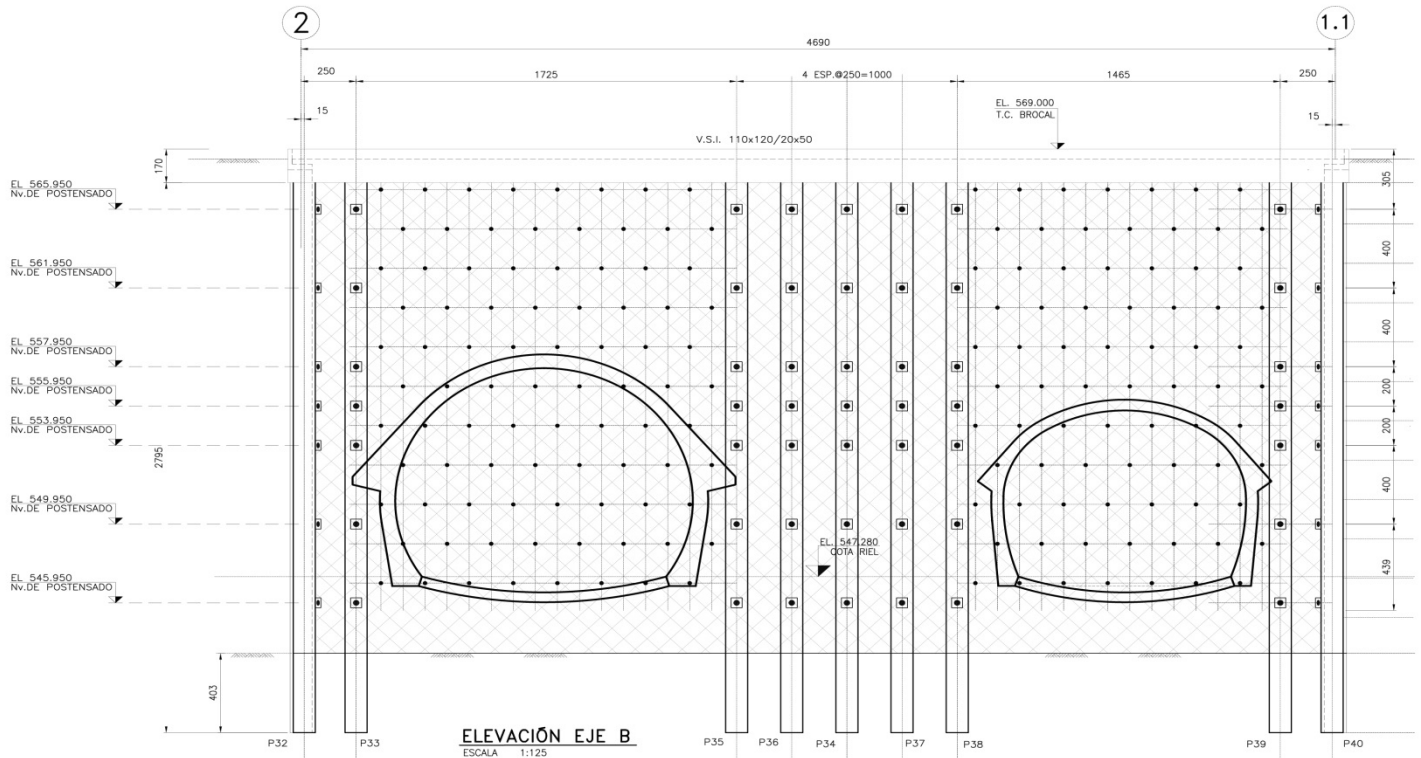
Vista en Corte del Soil Nailing la Estación Estadio Nacional
